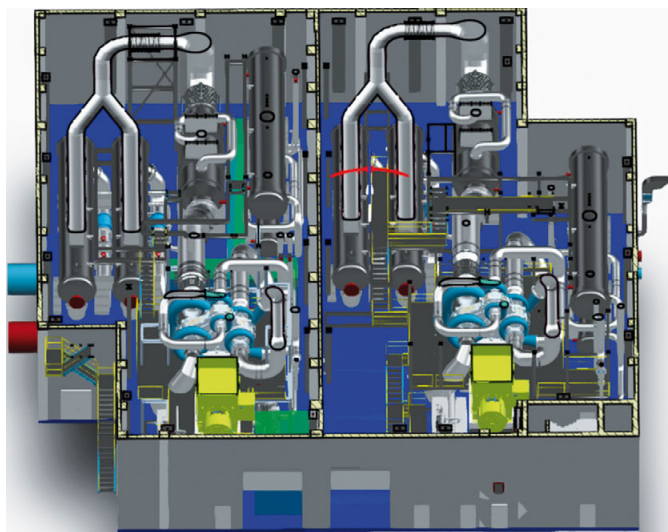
Aktueller Planungsstand: Innenansicht 3D-Modell Wärmepumpe WPA2. Quelle: STRABAG Umwelttechnik.
